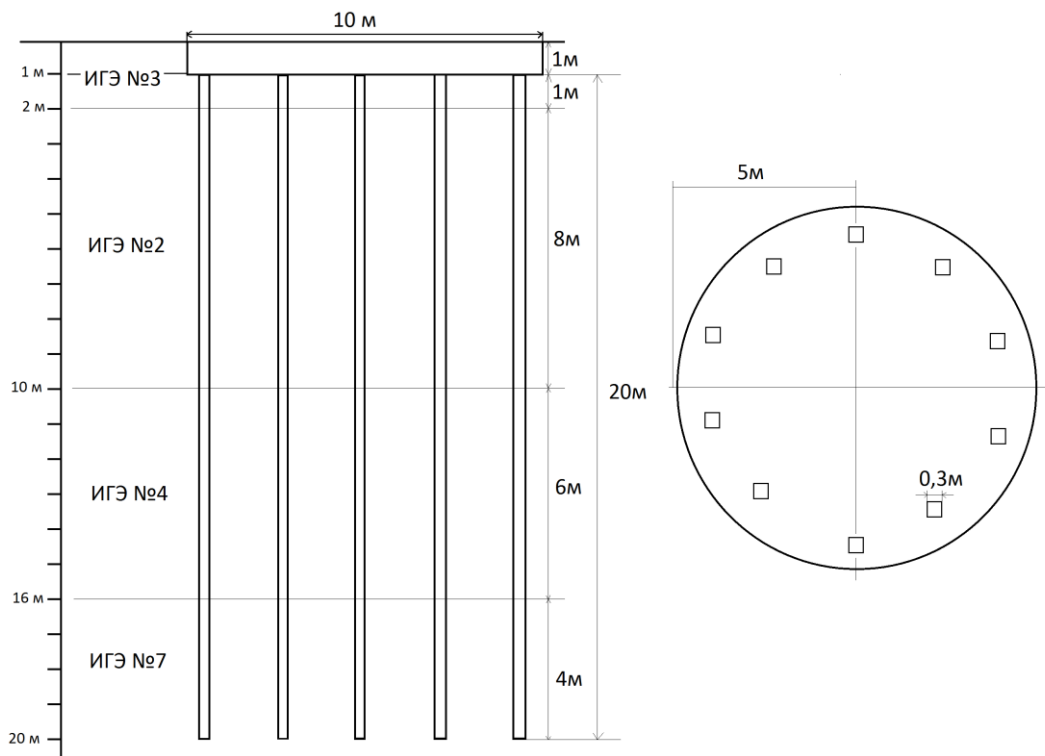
Схема плитно-свайного фундамента ветроэнергетической установки.
